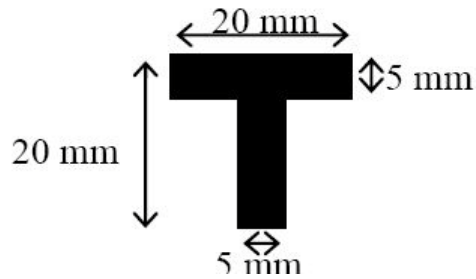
Sezione tipica degli elementi di trave longitudinali e trasversali
